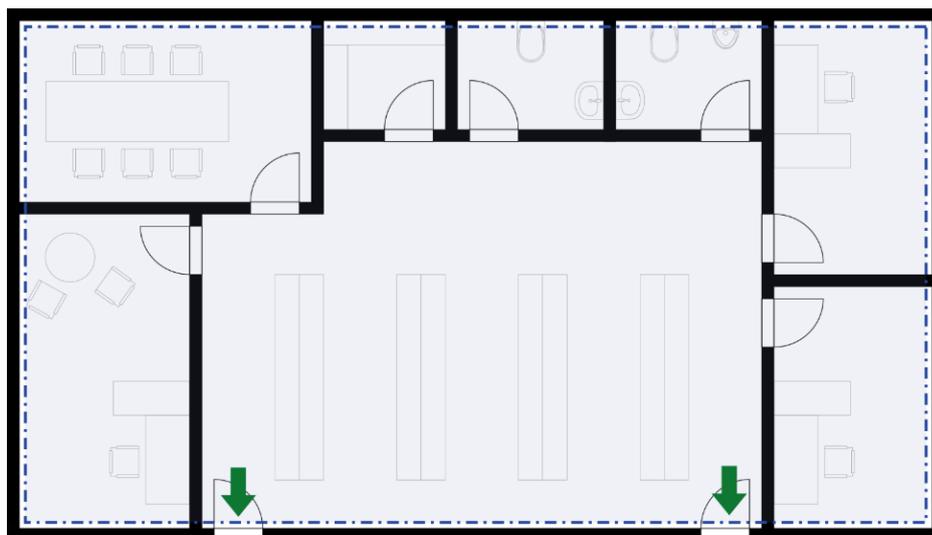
Prinzipskizze (Grundriss) - Beispiel einer erdgeschossigen Gewerbeeinheit ohne Flurstruktur
